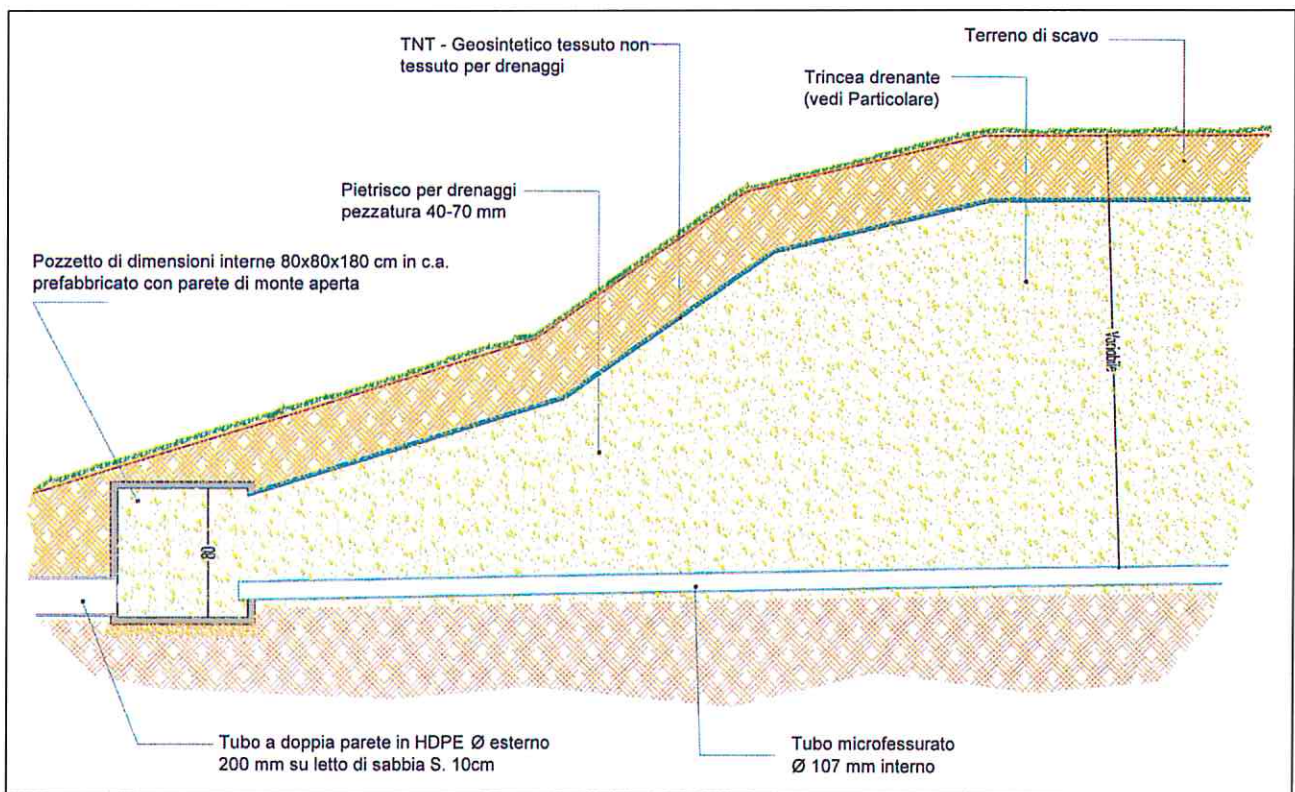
prospettiva tipo di scarico delle trincee drenanti
